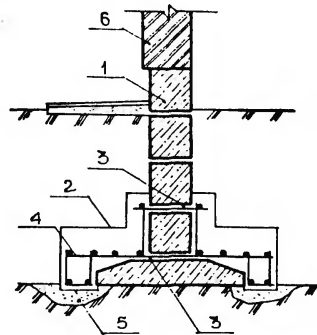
Увеличение опорной площади устройством железобетонной обоймы
